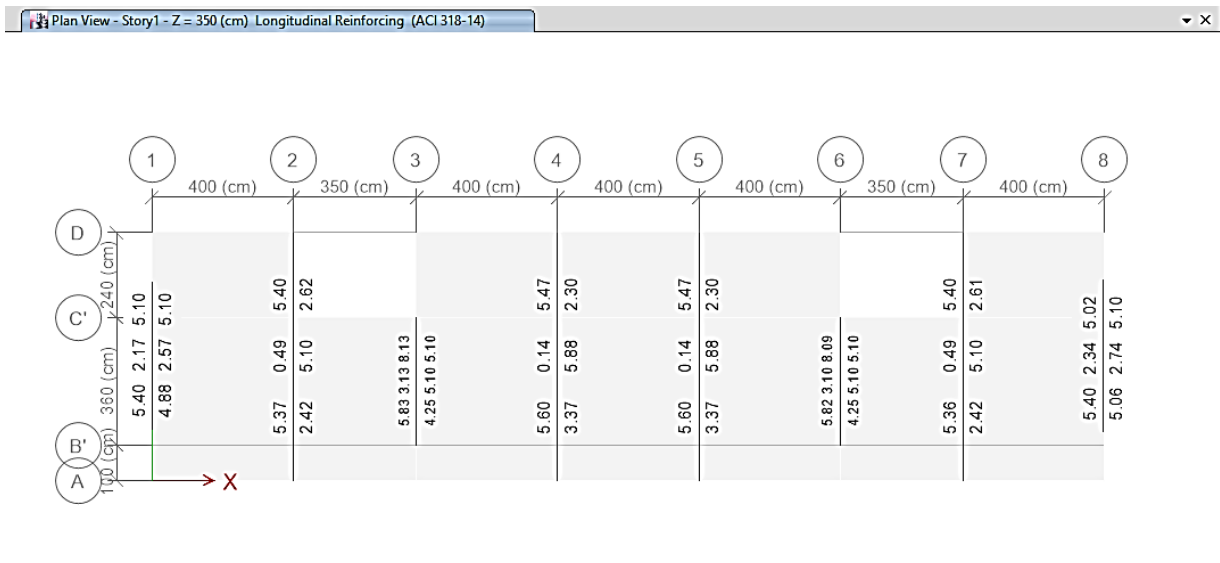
Refuerzo Longitudinal en cm² para vigas del Nivel 1
